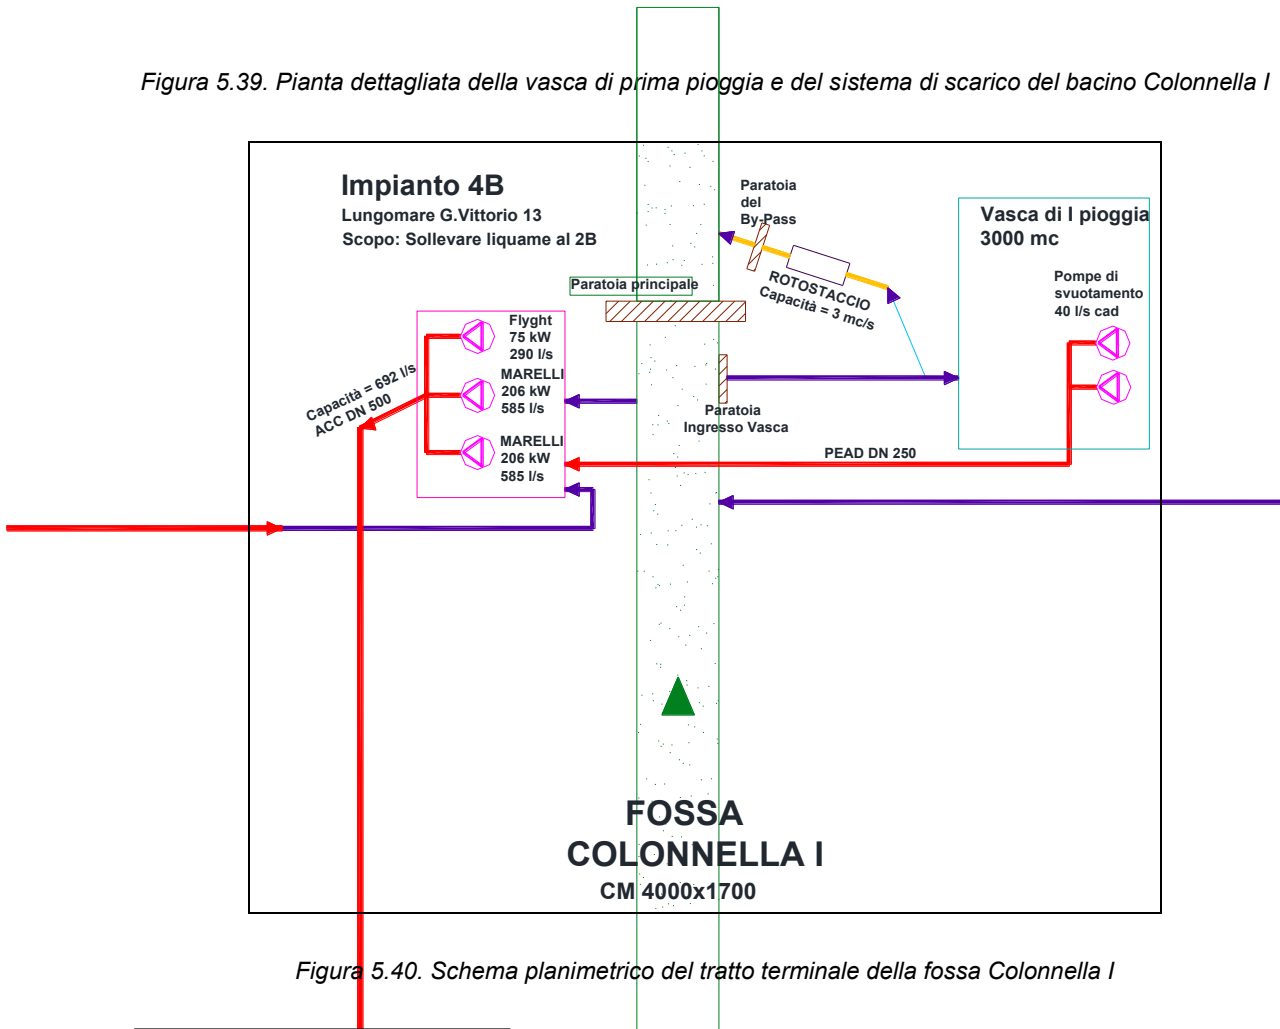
Schema planimetrico del tratto terminale della fossa Colonnella I
